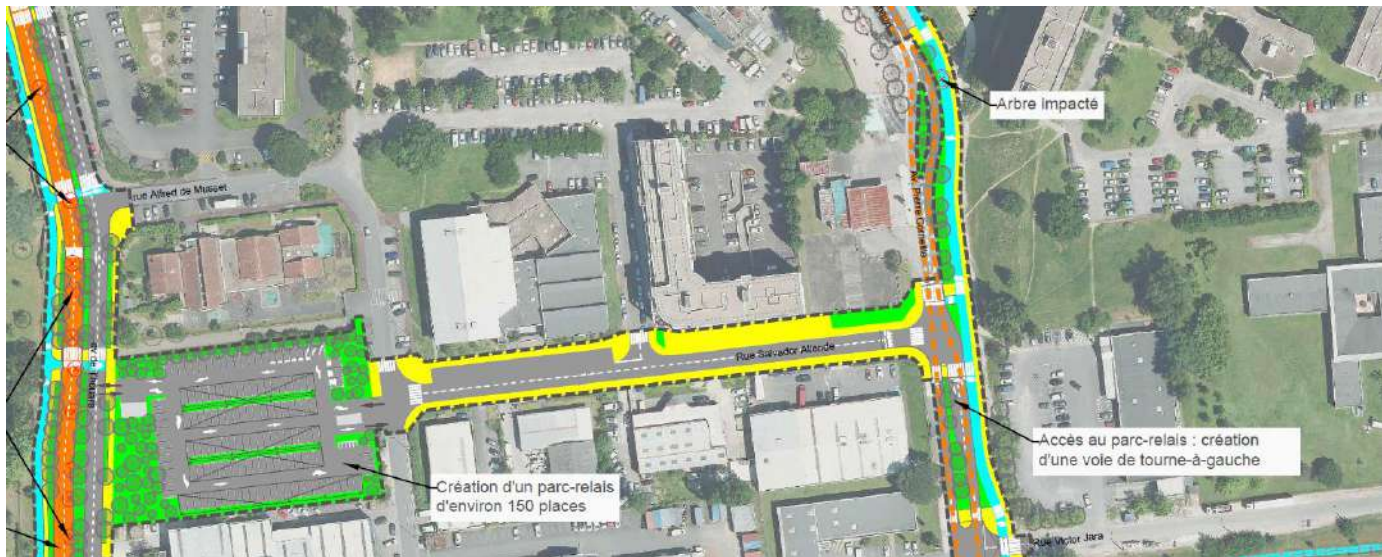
Extraits de plan sur l'insertion sur l'avenue Pierre Corneille
